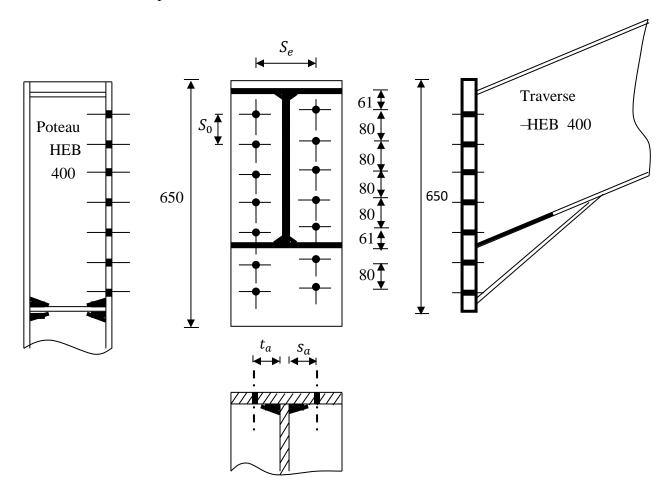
Schéma d'assemblage (poteau-traverse)
